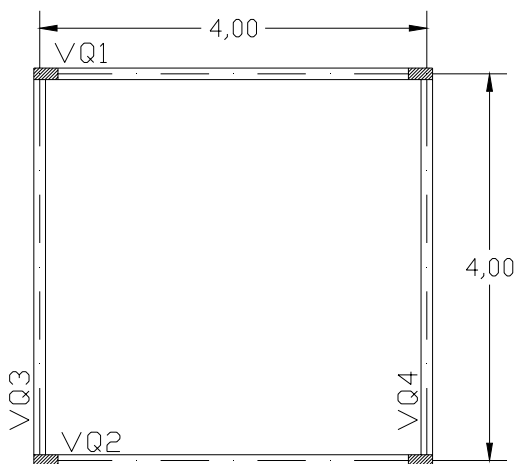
Pavimentos (PQ) com painel isolado quadrado (4m X 4m)
